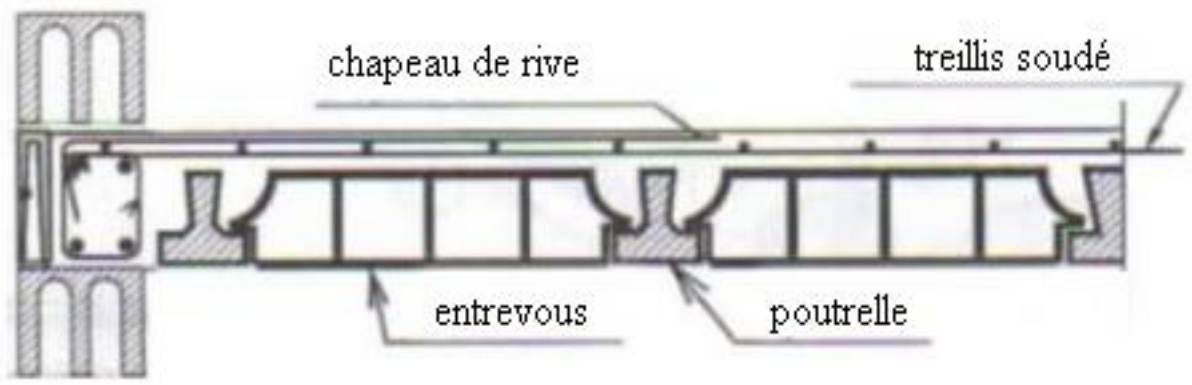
Coupe verticale d'un plancher en corps creux.
